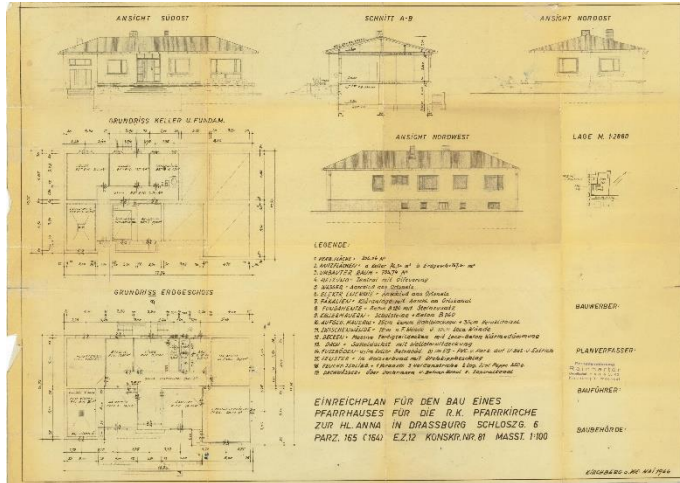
Einreichplan Pfarrhaus Draßburg.
